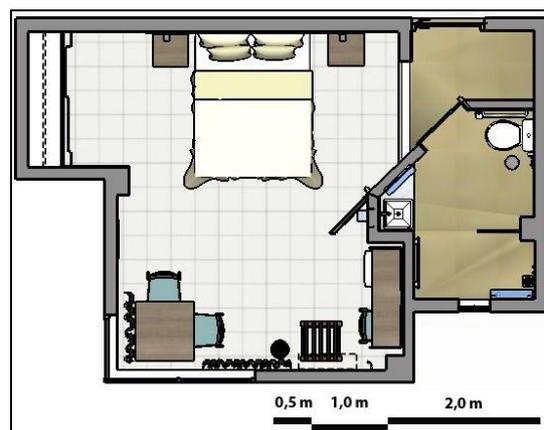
planta-baixa e layout do quarto adaptado do Hotel D
